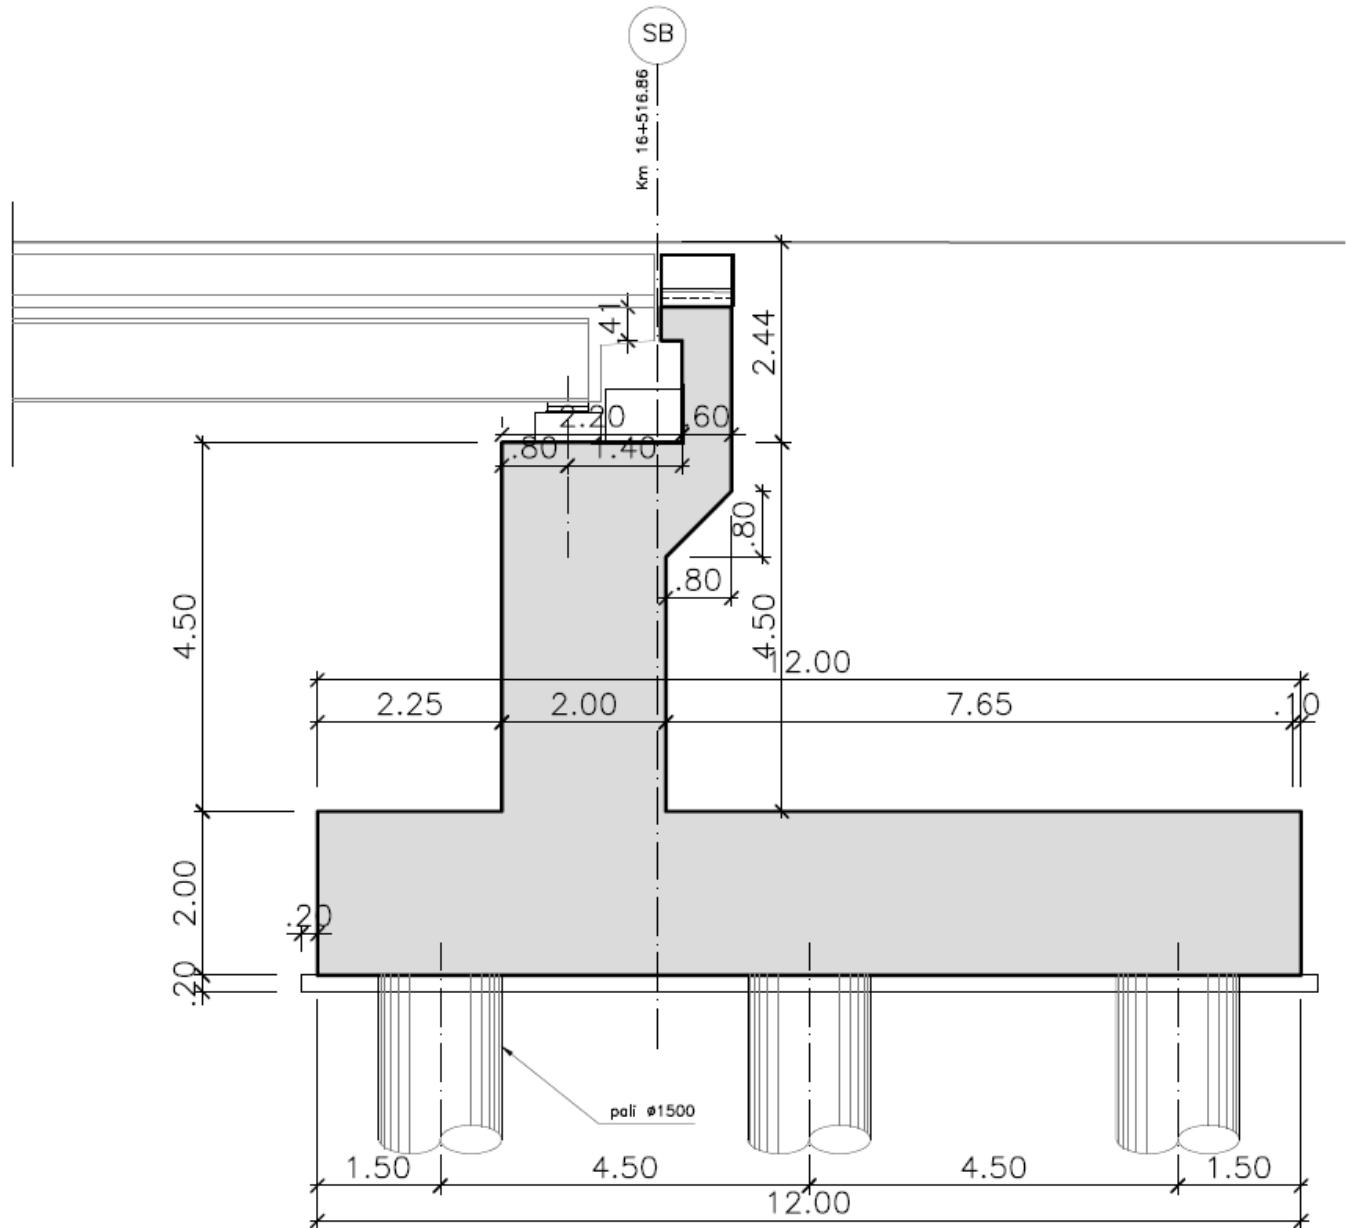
Sezione longitudinale Spalla “B”.
